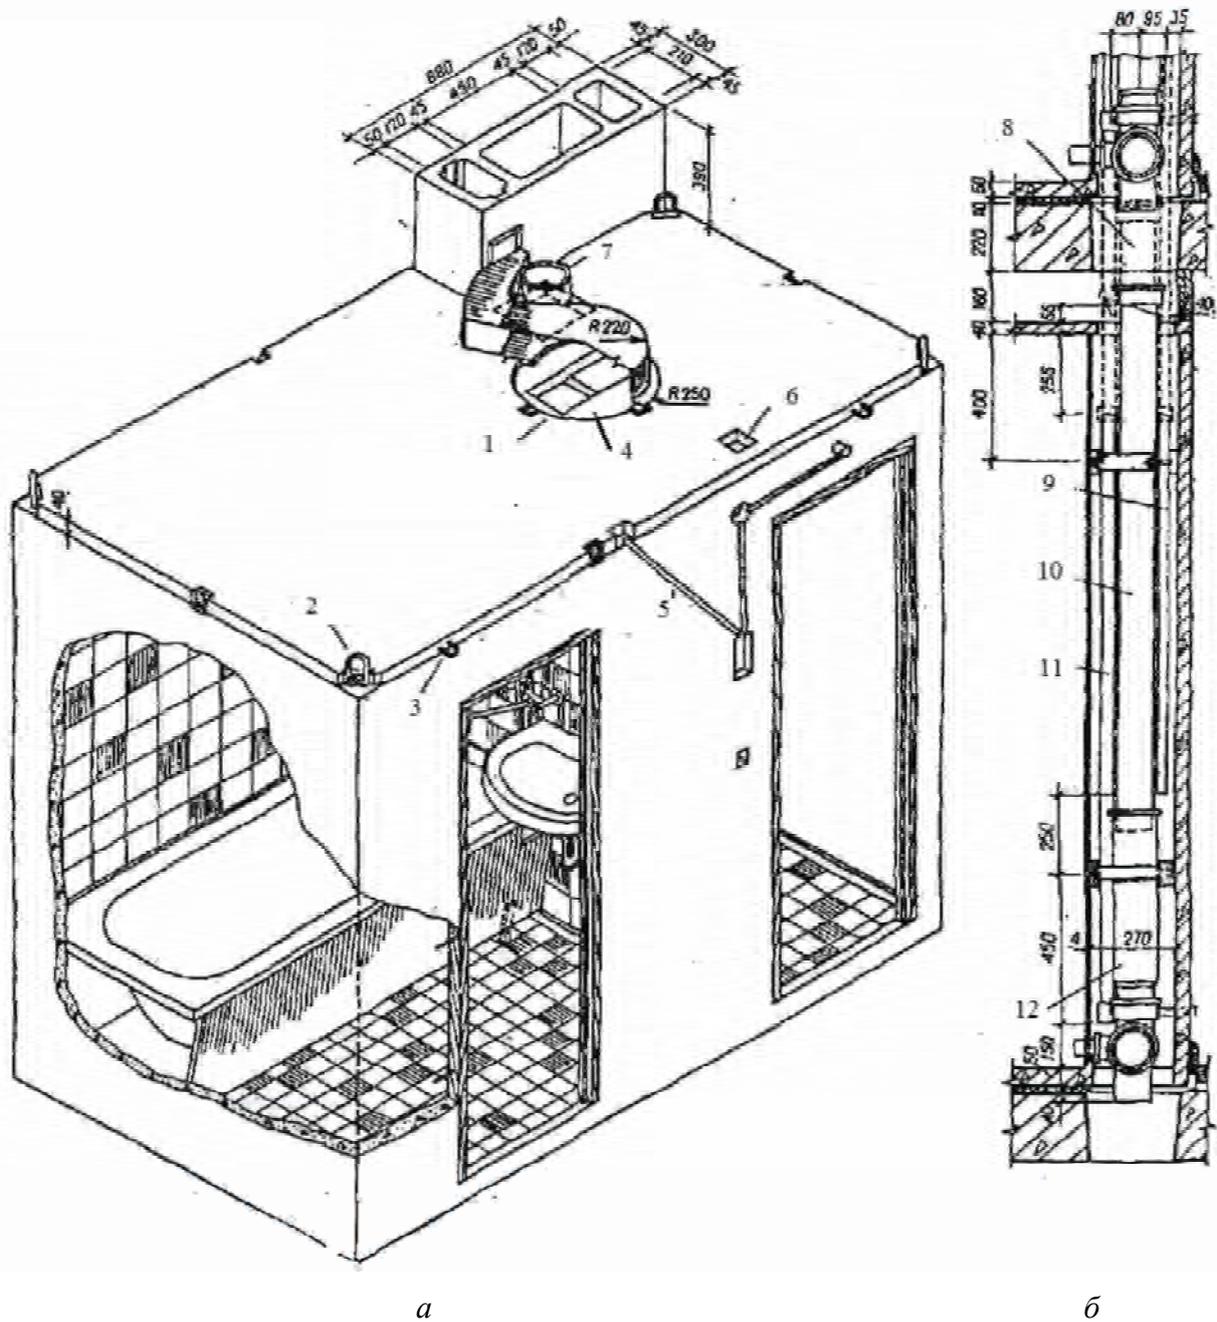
Разобшенная санитарно-техническая кабина типа «стакан»: *а* — общий вид кабины; *б* — схема монтажа стояков: 1 — вентиляционный поворотный патрубок из оцинкованной кровельной стали; 2 — строповочные петли; 3 — монтажные петли; 4 — вентиляционное отверстие; 5 — штробы для электропроводки; 6 — отверстие для стояка полотенцесушителя; 7 — канализационный стояк; 8 — выдвигание стояка из компенсации откоса патрубка; 9 — циркуляционный стояк; 10 — канализационный стояк; 11 — вентиляционный канал; 12 — компенсационный патрубок
